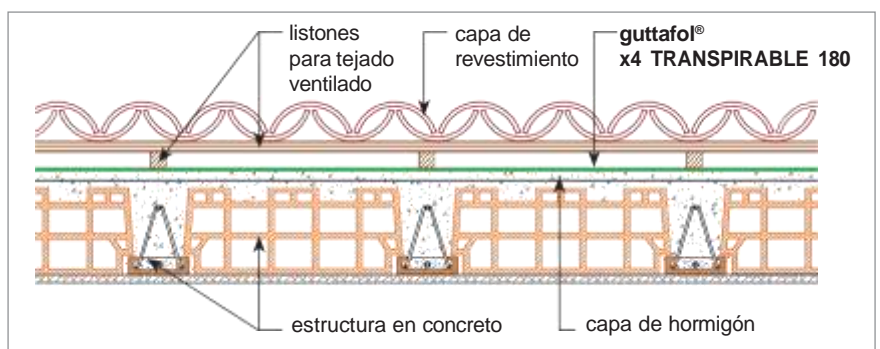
guttafol® x4 TRANSPIRABLE 180 colocado directamente sobre la capa de hormigón con cámara de ventilación
